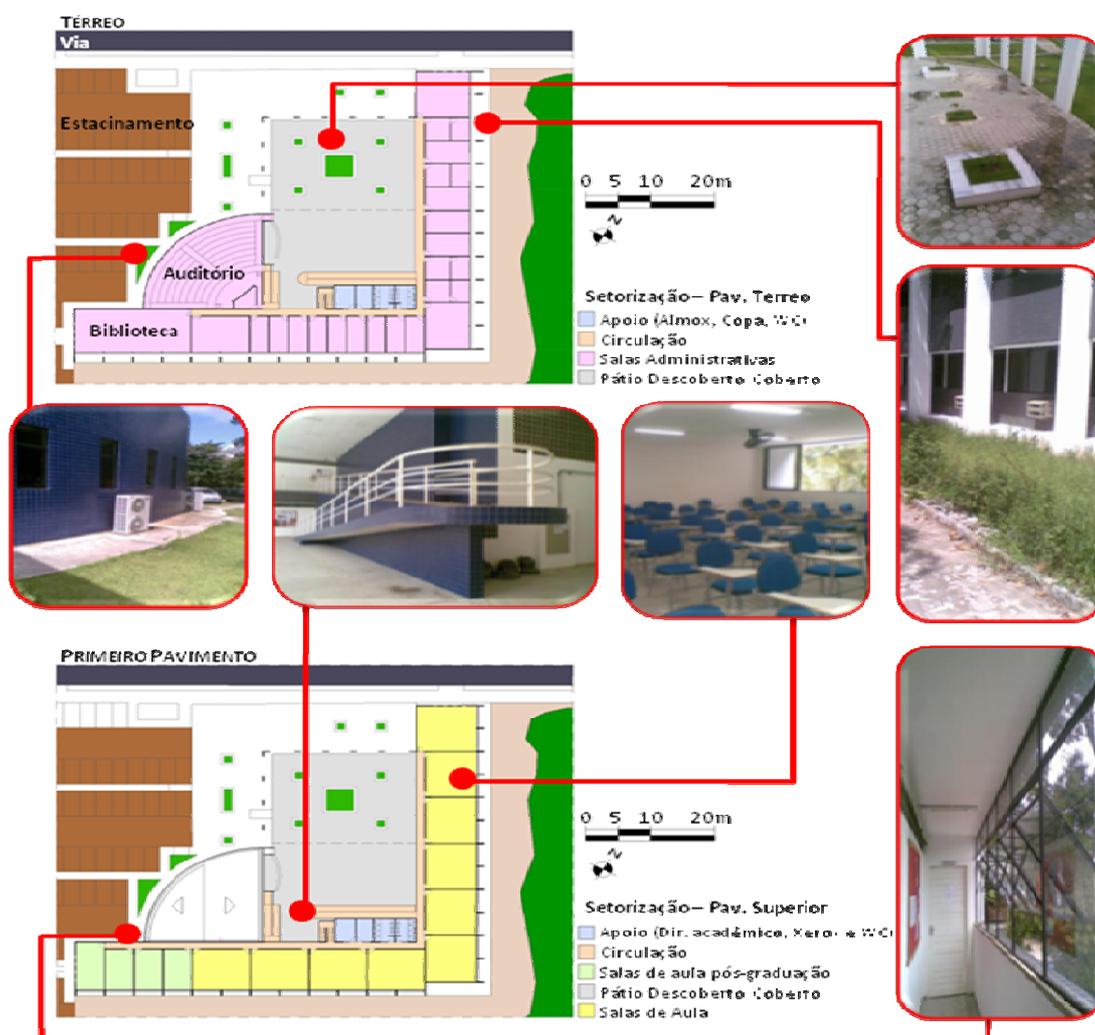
Setorização do pavimento térreo e do primeiro pavimento do CCJ/UFPB. Fonte: Arquivo da Prefeitura Universitária - UFPB, modificado pelas autoras. Acervo do grupo, 2010.
